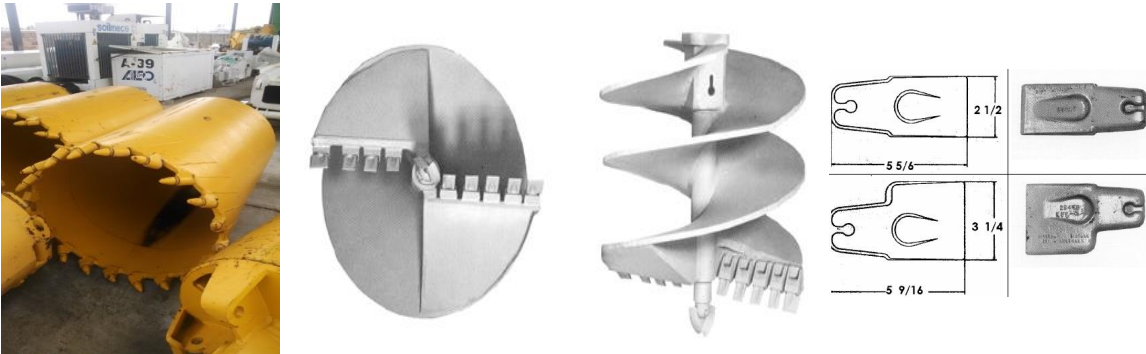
y 31 .Herramienta de perforación. Pilas en Tobas
